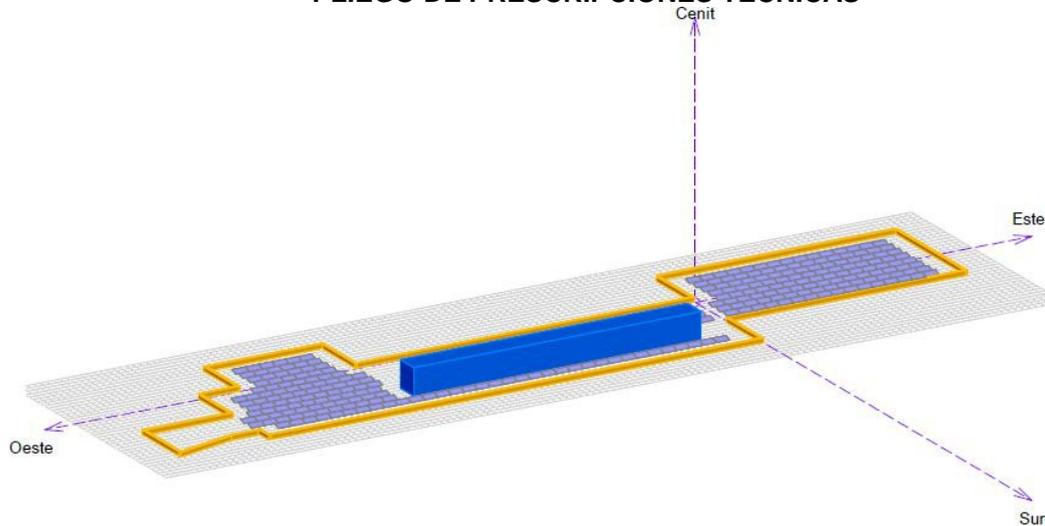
Cubierta de colocación de paneles en la cubierta sur edificio Betancourt
